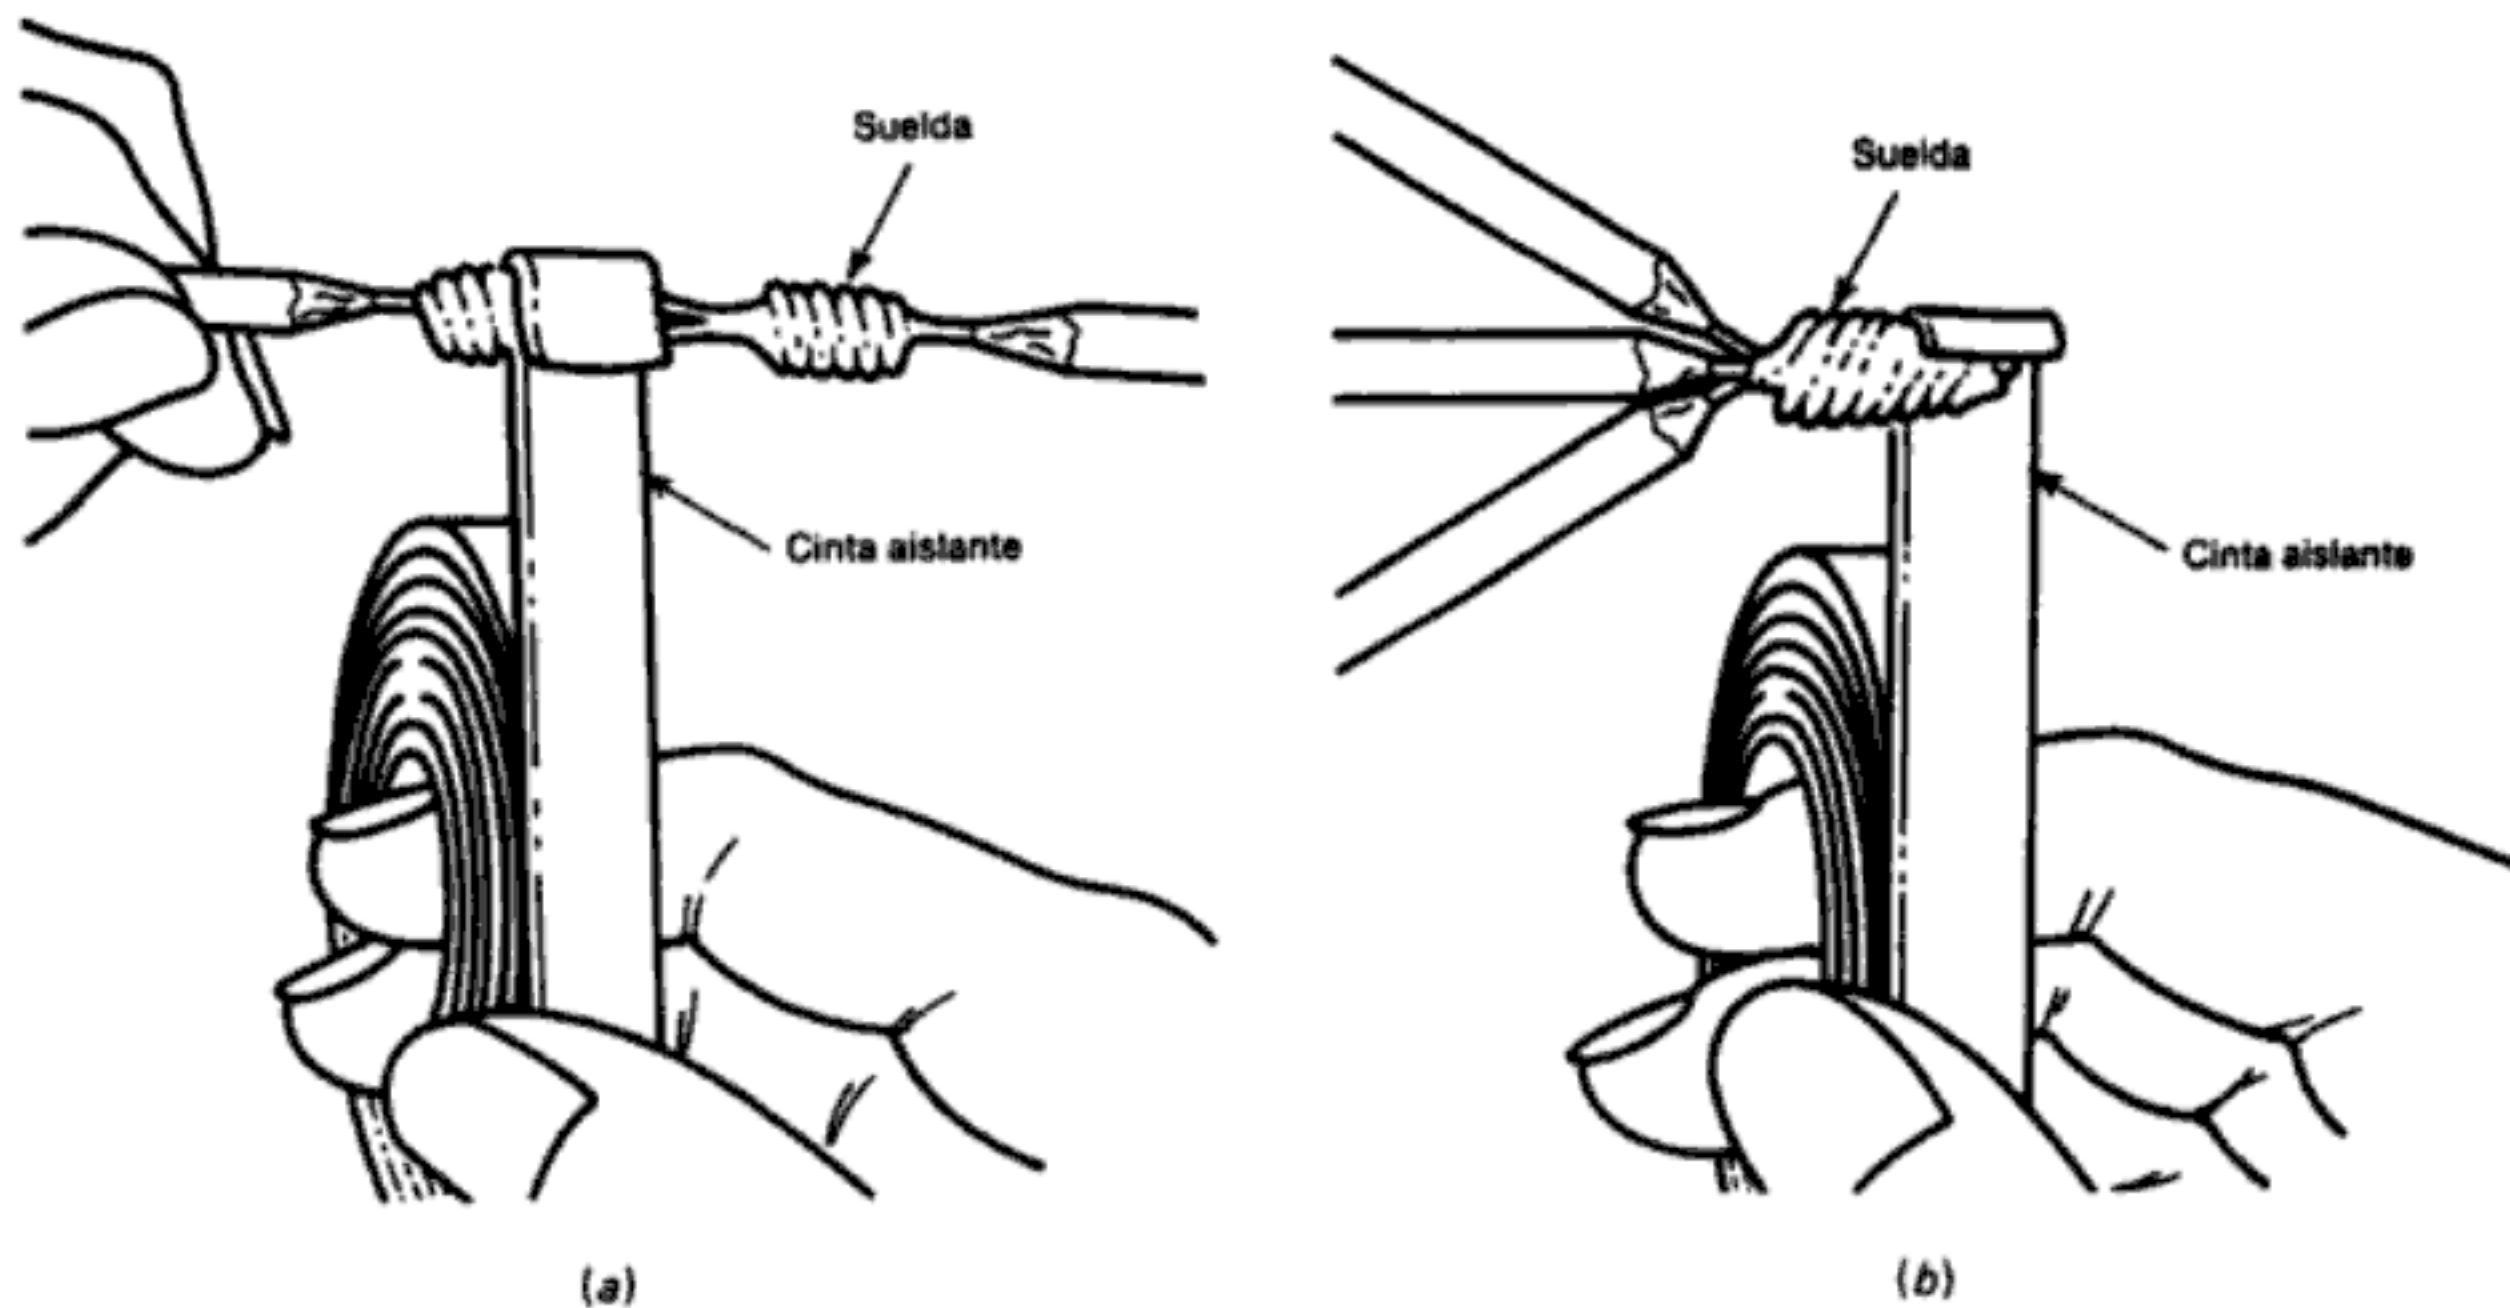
(a) Encintado de una unión soldada. (b) Encintado de un empalme arracimado.
